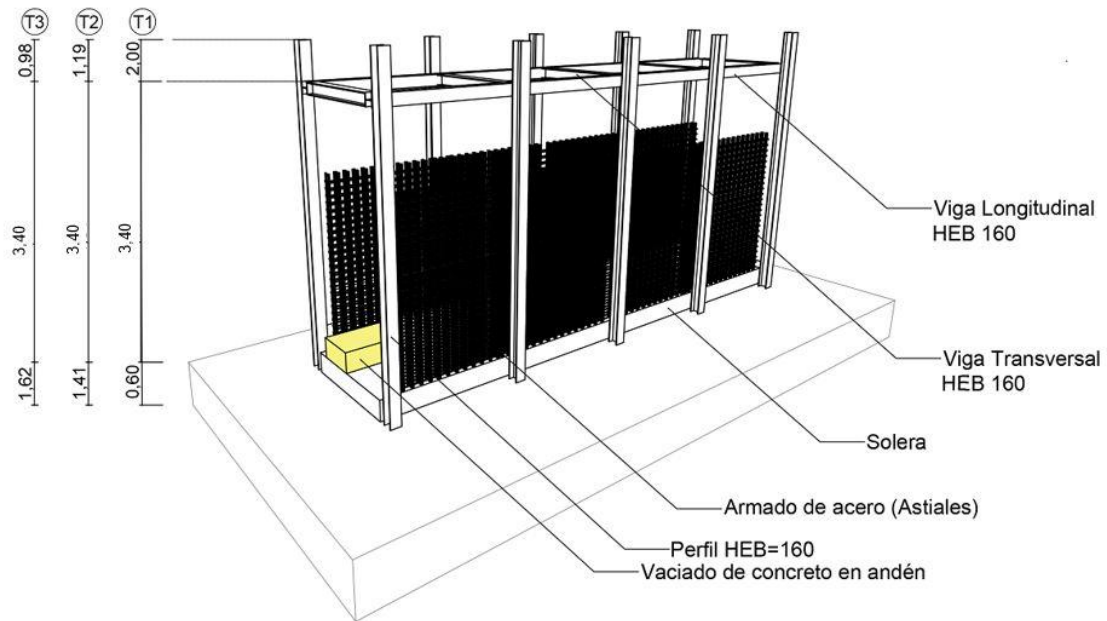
D5-Hormigonado andén sección de tramo 1-2-3
